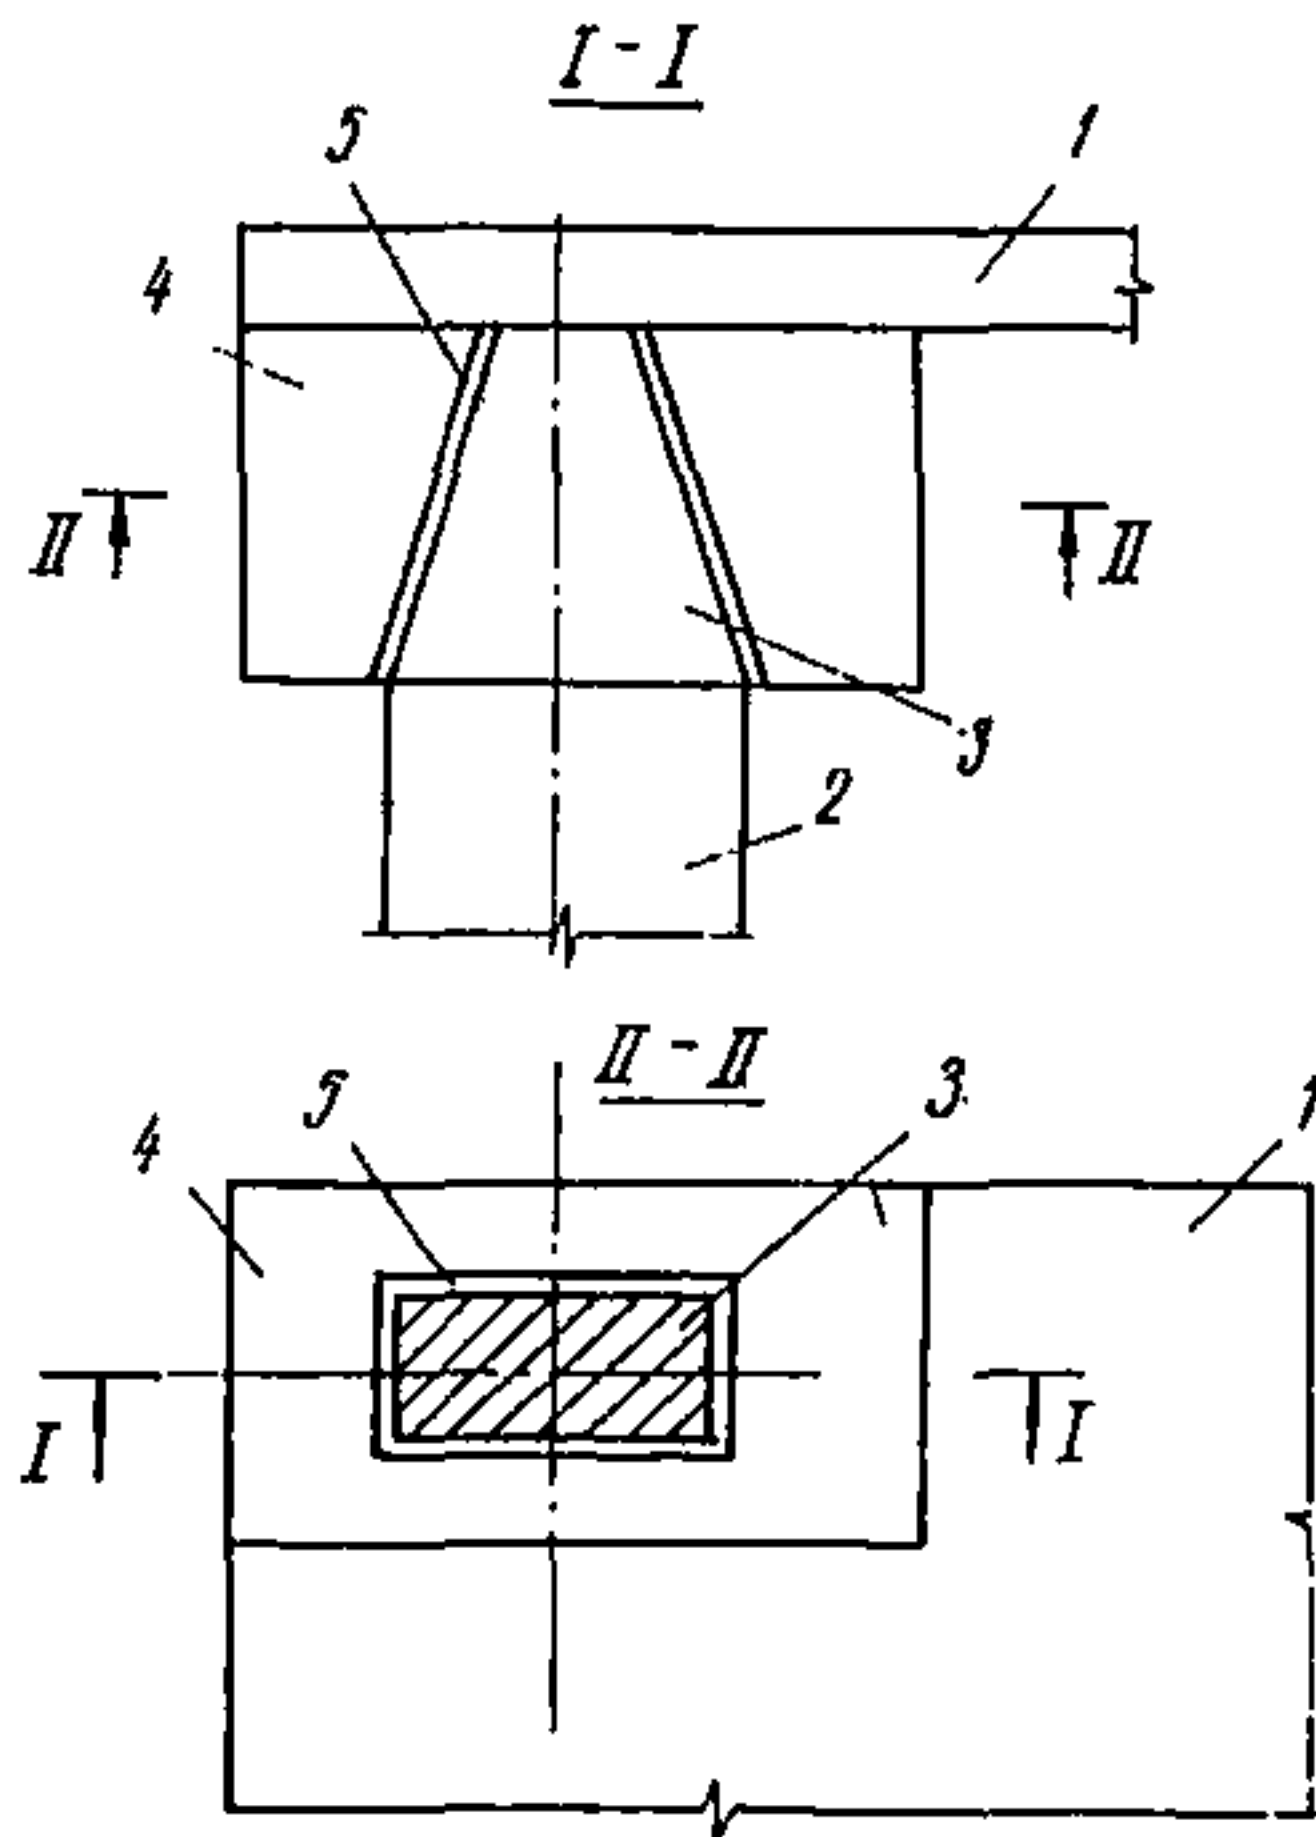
Стык верхней плиты с колоннами этажерки с применением железобетонных капителей
